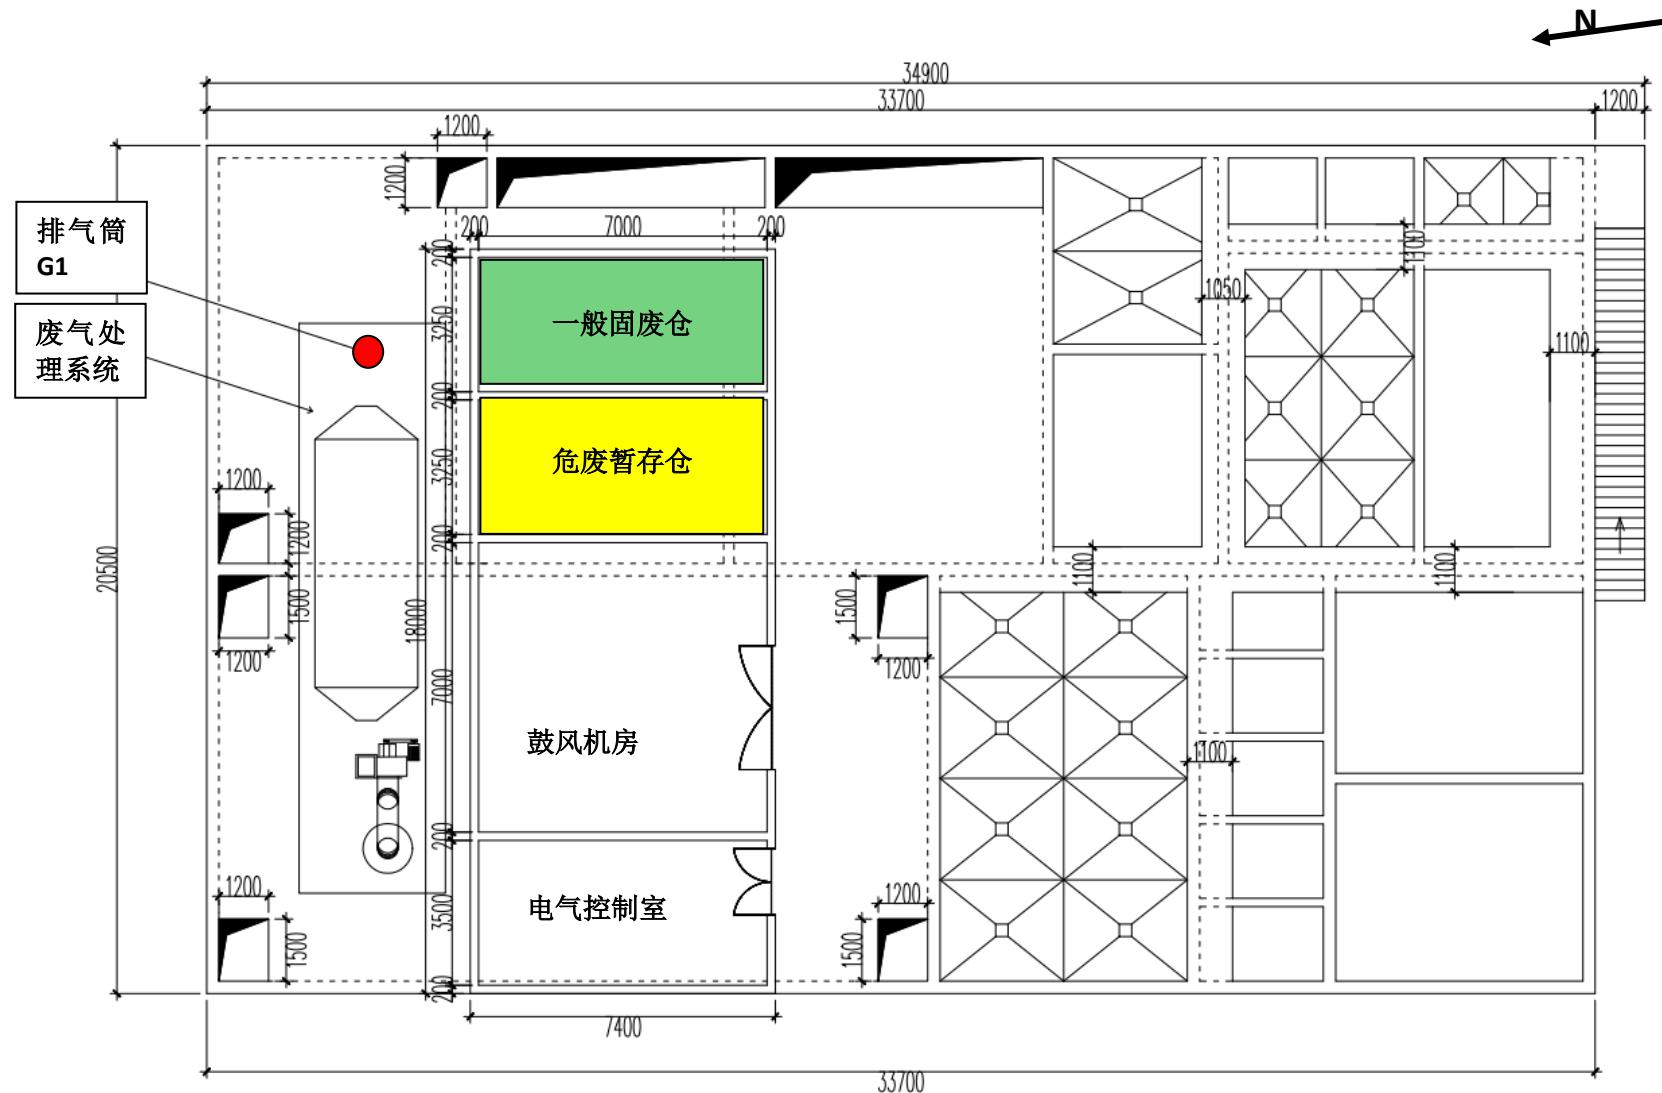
处理构筑物1三层平面布置图（6.1~9.6m）
